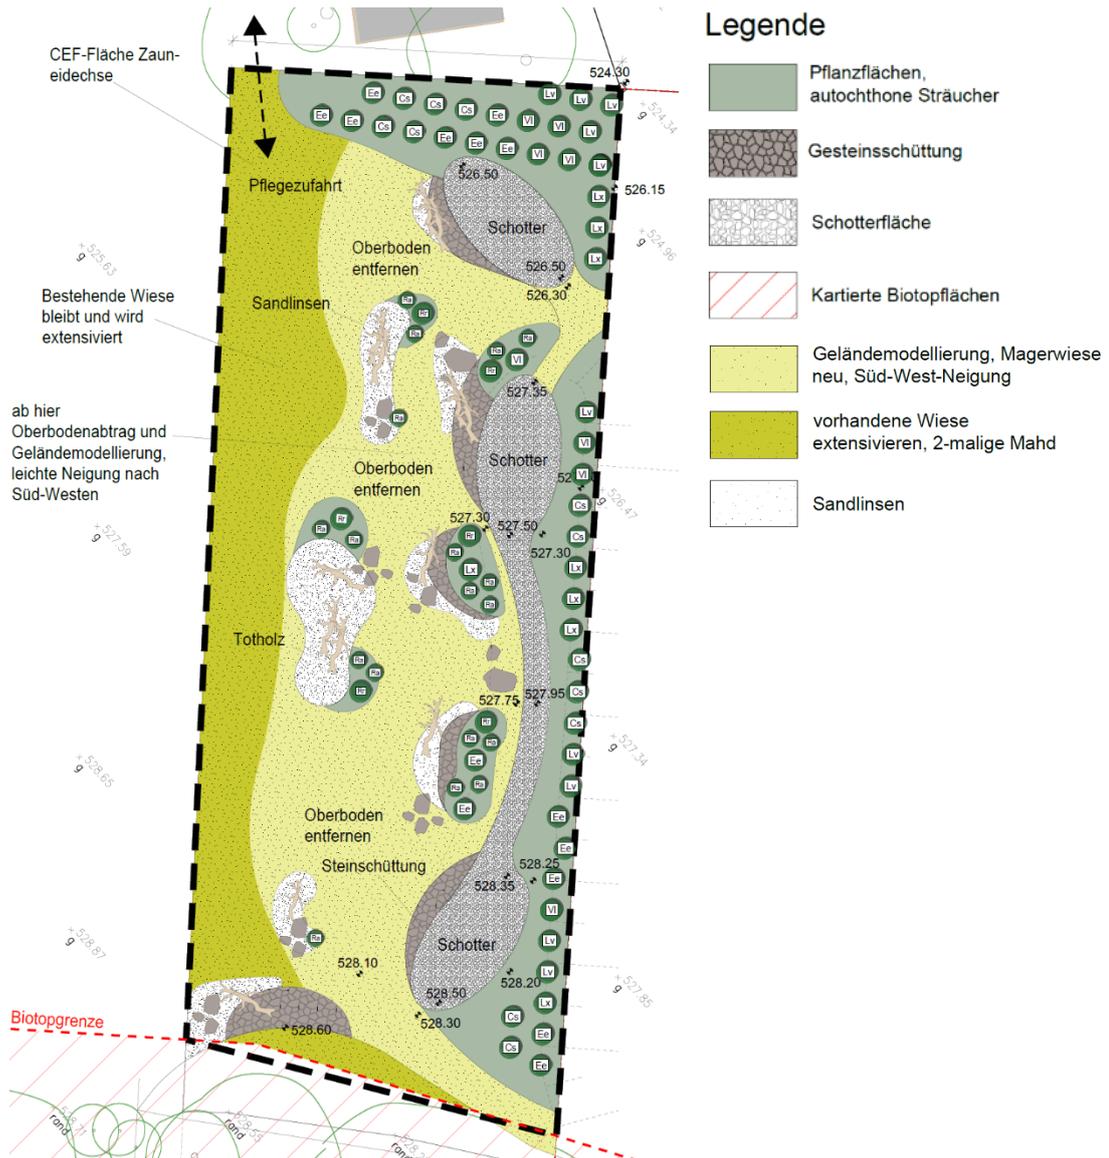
Ausschnitt Ausführungsplanung, CEF Fläche Zauneidechsenhabitat, A. Oberbauer, 16.11.2022
